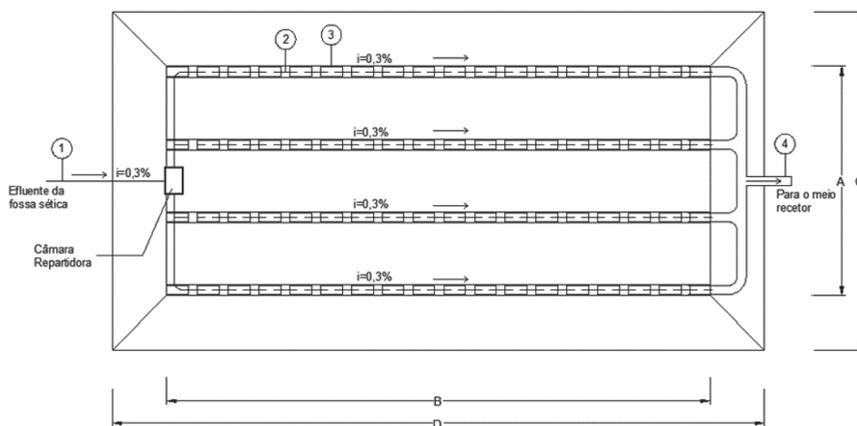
Planta esquemática do aterro filtrante proposto para o caso de estudo (adaptado de Bartolomeu, 1996).
